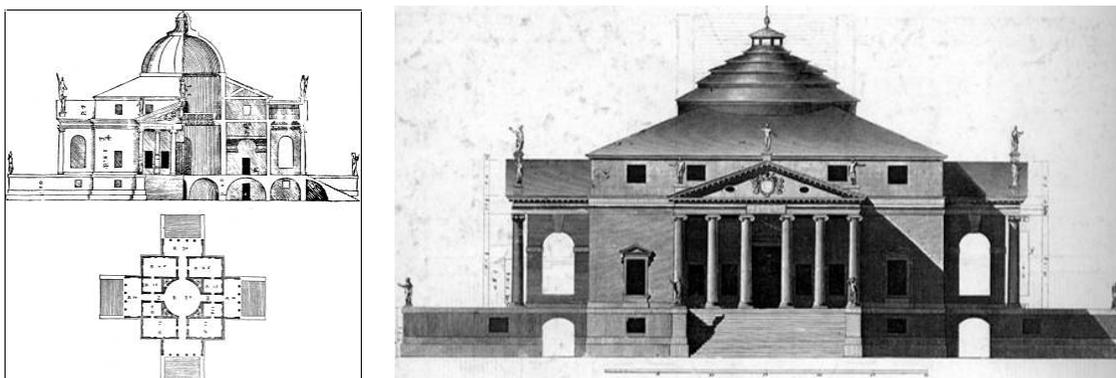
e 69 – Villa Capra – Planta, Elevação e Ilustração
